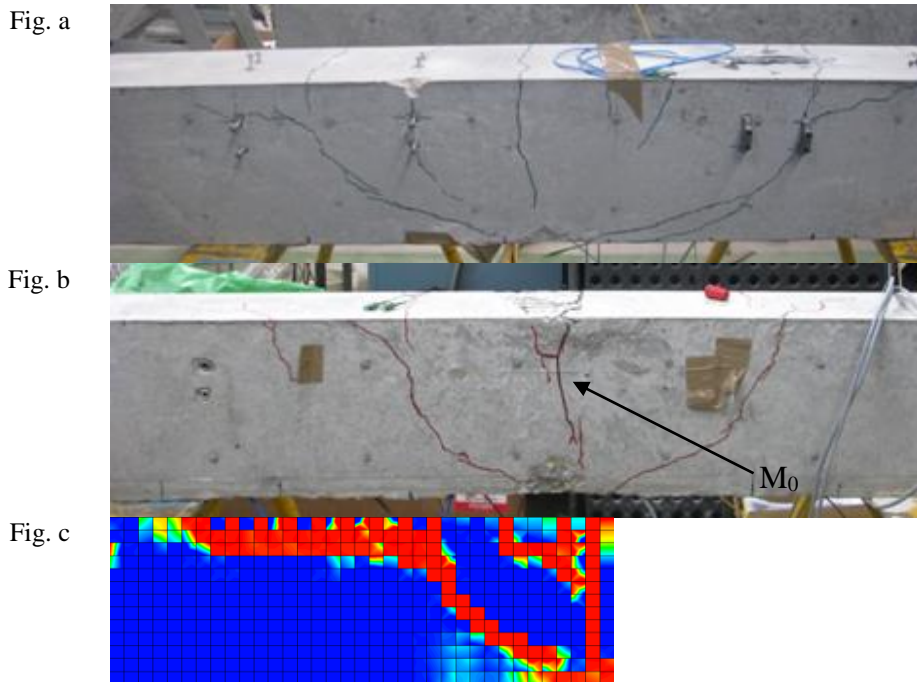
Profils de fissuration réels des poutres 1 (a) et 2 (b) et profil de fissuration simulé sur une moitié de poutre (c) en parement. Sur la poutre 2, on peut voir le capteur  $M_0$  collé en surface.
